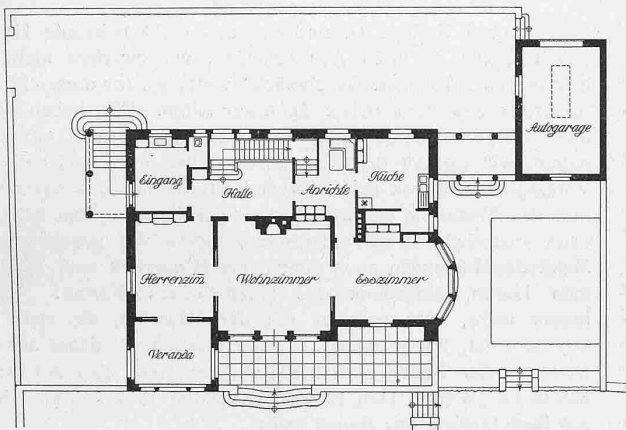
u. 4. Grundrisse 1:400.
